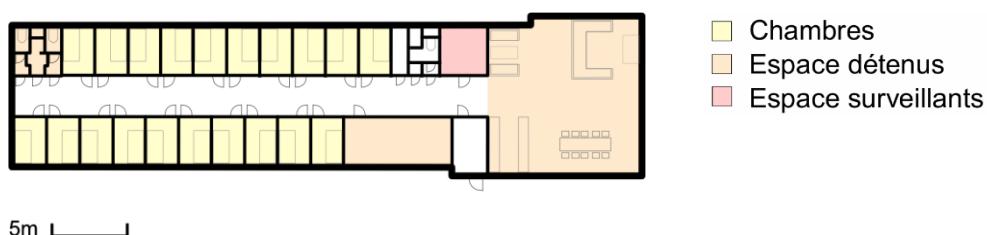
Plan du rez-de-chaussée du bâtiment 4a
